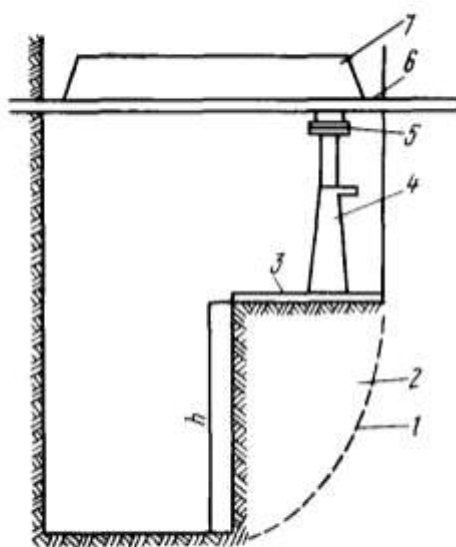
Схема установки для проведения испытаний на сдвиг обрушением. 1 — поверхность обрушения; 2 — целик (призма) грунта; 3 — штамп; 4 — домкрат; 5 — динамометр; 6 — упорная балка; 7 — нагрузка
